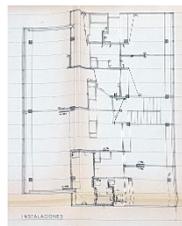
Planta Instalaciones B-2-2. 1964. Fuente: Archivo Municipal da Coruña
